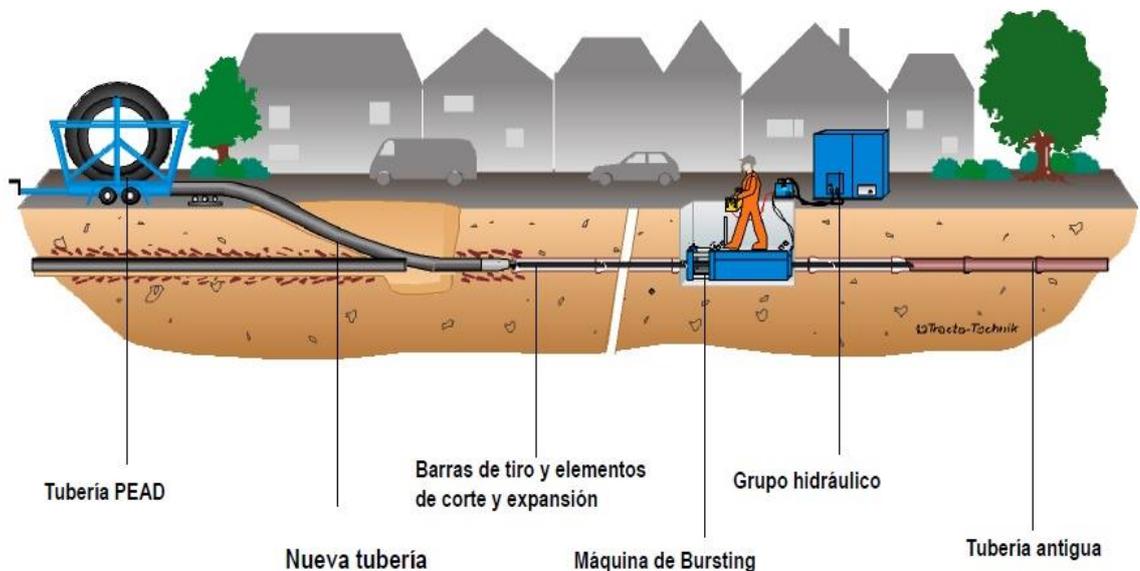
Vista de excavación sin zanja en áreas congestionadas.
